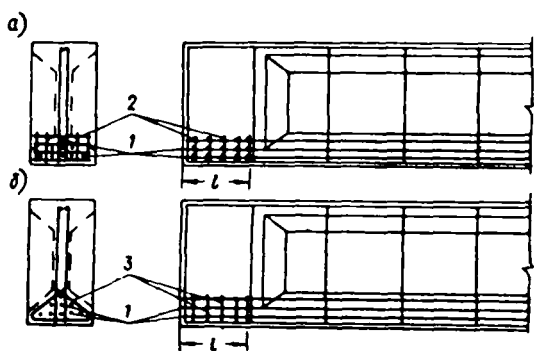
Усиление торцов предварительно напряженных конструкций
